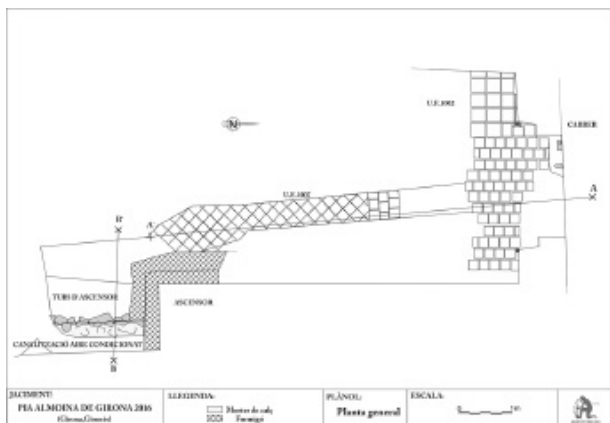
Planta general dels paviments i mur localitzats a la Pia Almoina de Girona.
